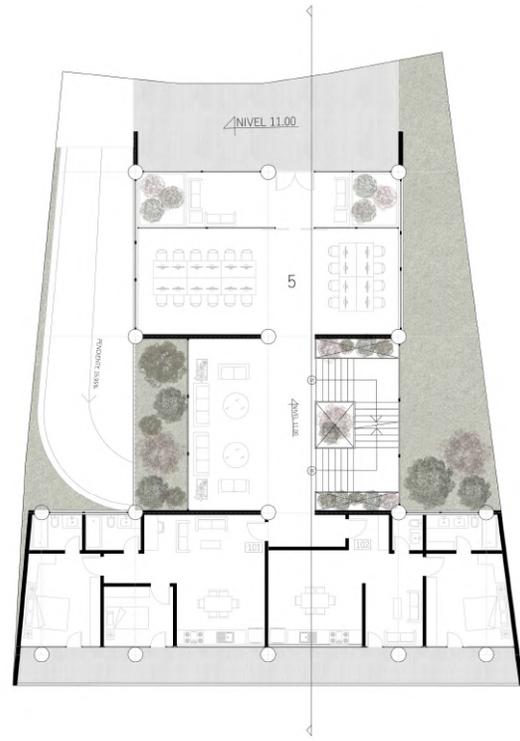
Planta baja Nivel 11.00 Vivienda multifamiliar. Elaboración Propia
